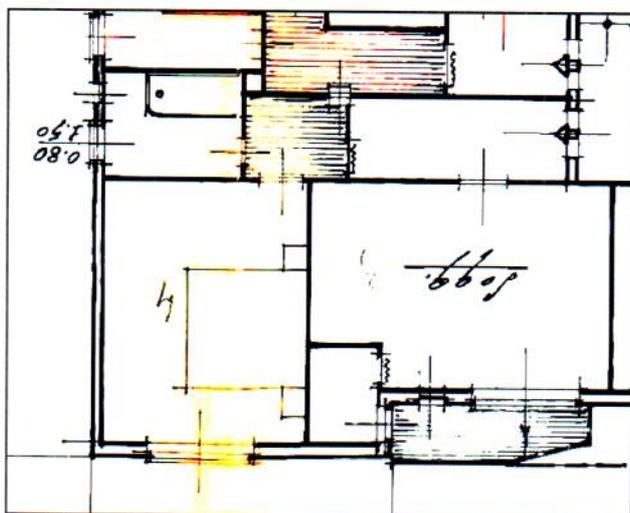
Planimetria allegata all'autorizzazione Edilizia n.13/60 dell'11.03.1960
